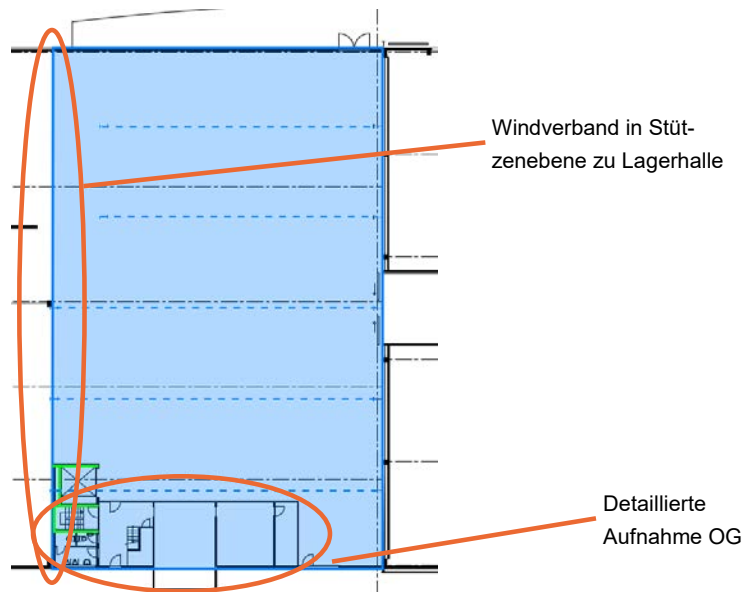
Grundriss EG Gebindehalle: mögliche Massnahmen am Tragwerk
